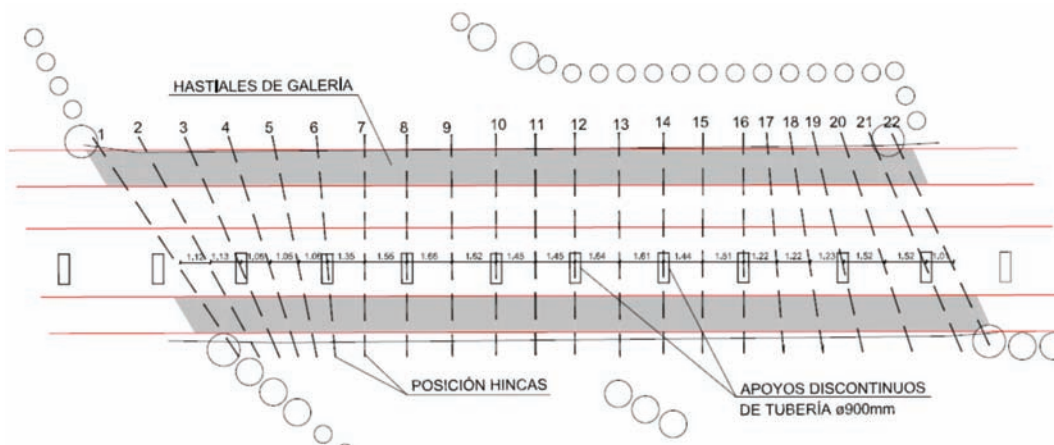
Distribución en planta de los perfiles transversales de apeo.
